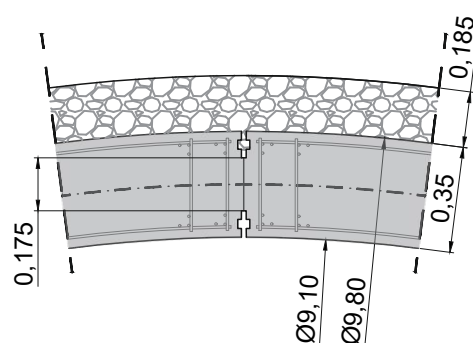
Tunnel 45 – Herkömmlicher Tunnelquerschnitt
